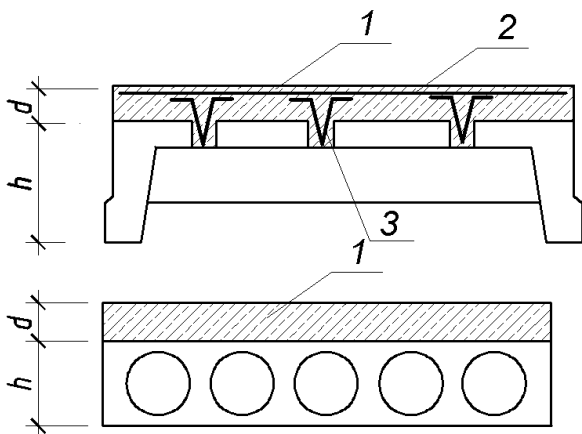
Підсилення плит нарощуванням стиснутої зони: 1 – шар нарощування; 2 – арматурна сітка; 3 – армована шпонка
